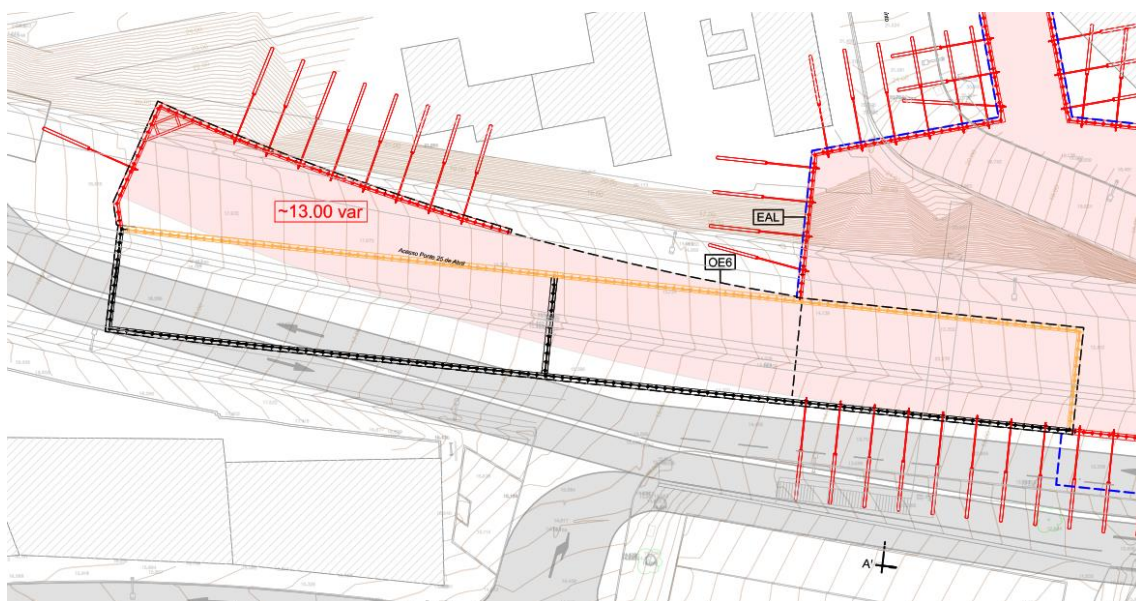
Planta de Dimensionamento Contenção Provisória – 3ª Fase de escavação
